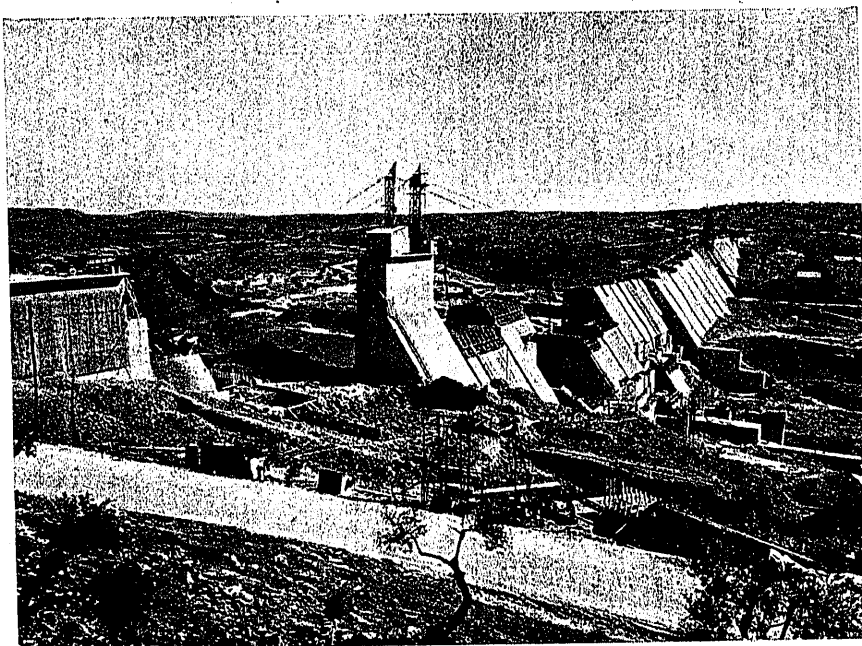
Presa de Orellana. Se aprecia la gran longitud de esta presa y los distintos sistemas de hormigonado utilizados. Al fondo, a la derecha, instalaciones de hormigonado.
